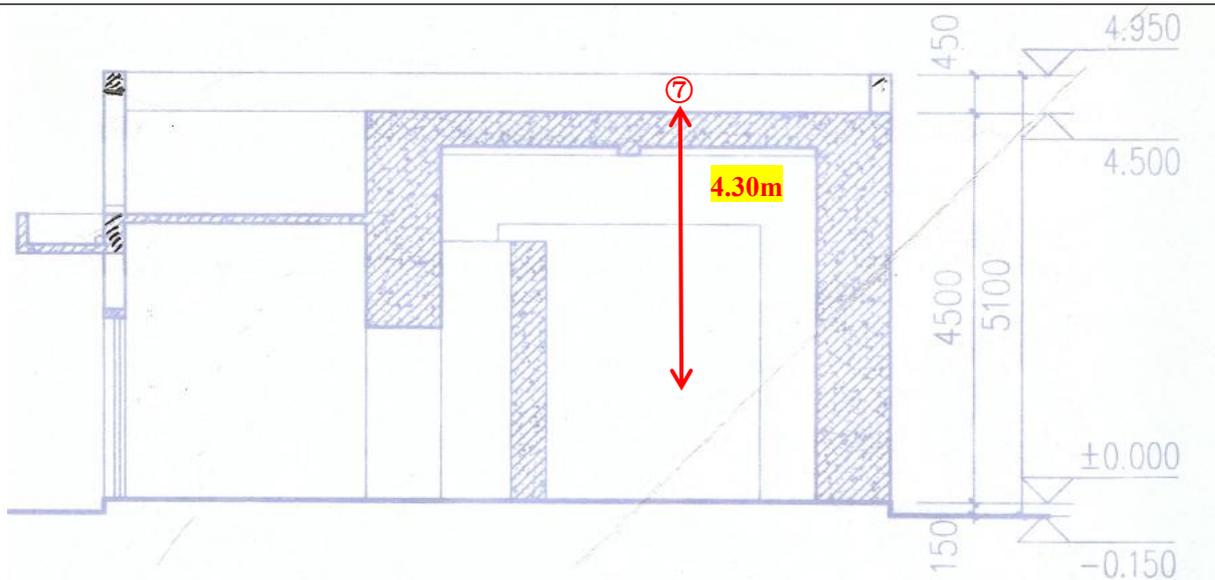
探伤室屏蔽结构剖面示意图及各关注点位置（单位：mm）
